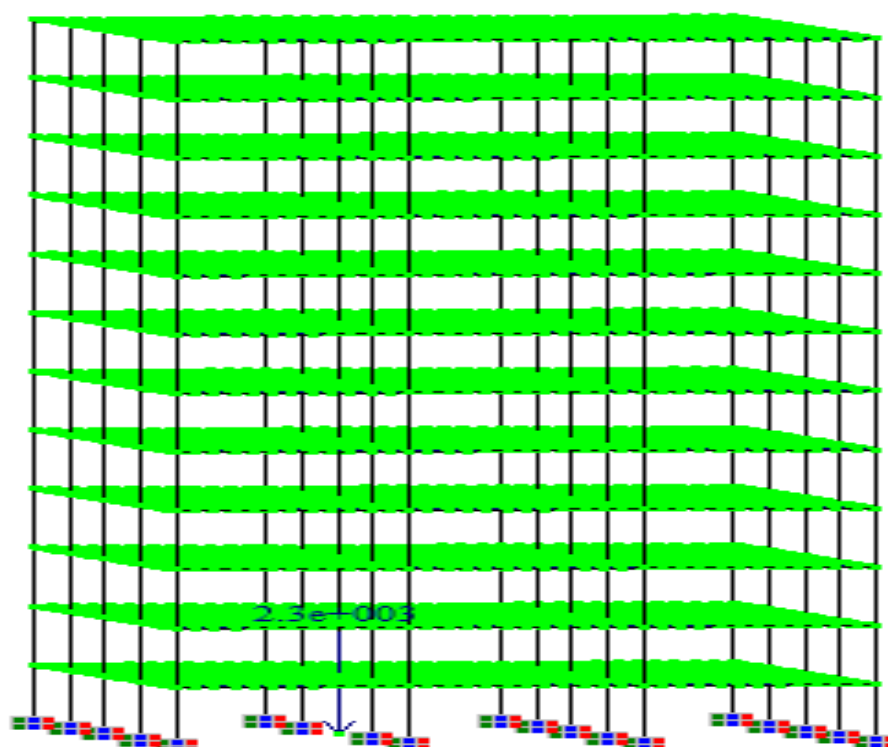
Schéma illustratif du modèle d'étude du bâtiment avec planchers sans hourdis à 12 niveaux avec un chargement vertical sur le poteau intermédiaire
